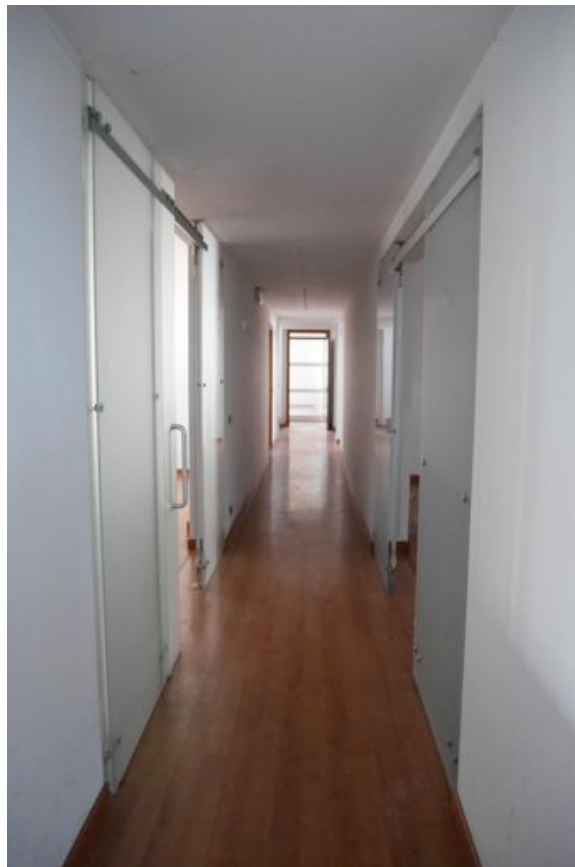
Il corpo ad uso uffici. Piano terra. Il corridoio verso il laboratorio/officina.
